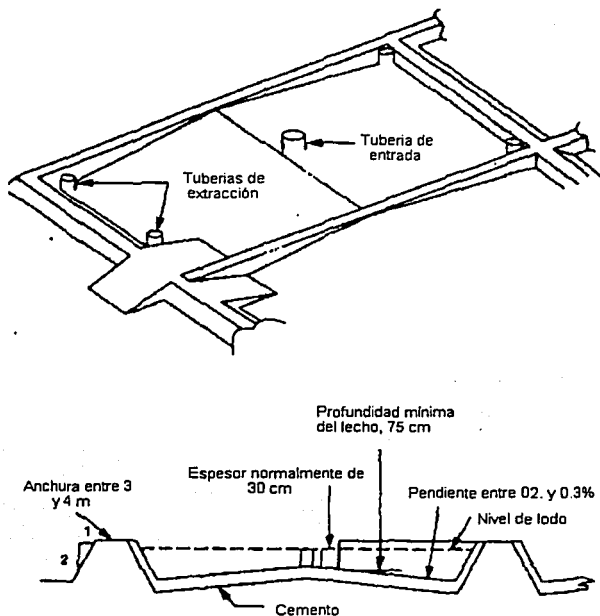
Lecho pavimentado diseñado para decantación y evaporación.
